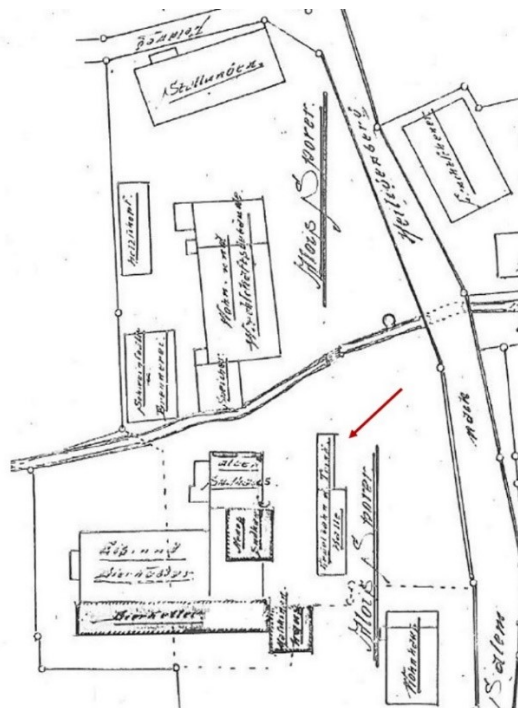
Lageplanausschnitt⁵ aus dem Baugesuch von 1901 zur „Erbauung eines neuen Bierkellers, Sud- u. Maschinenhaus“.
